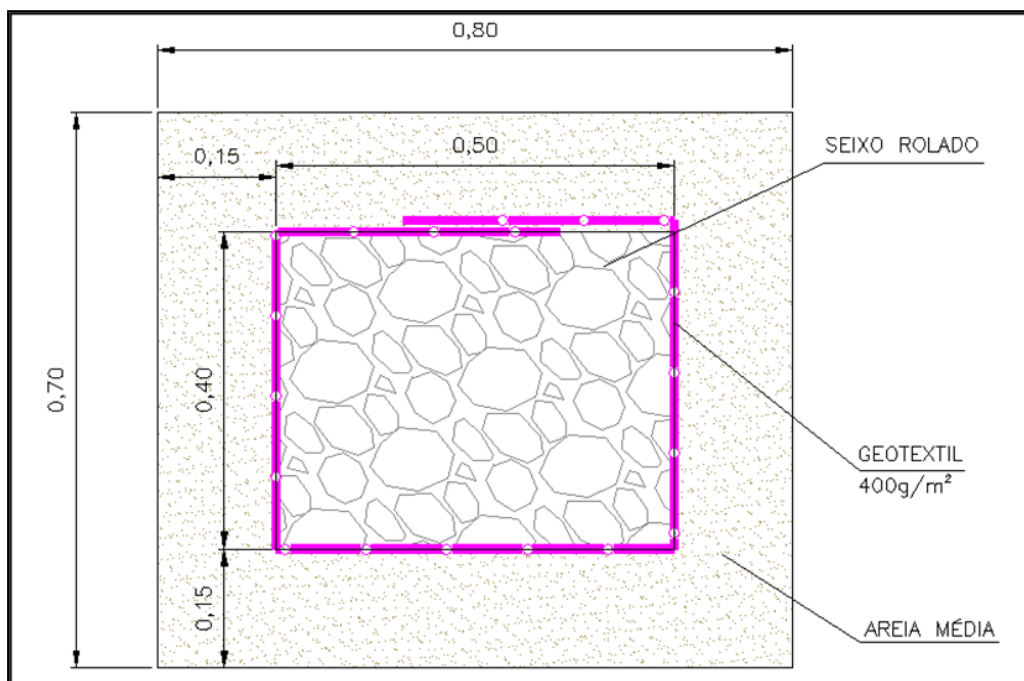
Detalhe Típico – Drenos (D1-3541-54-G-163)
